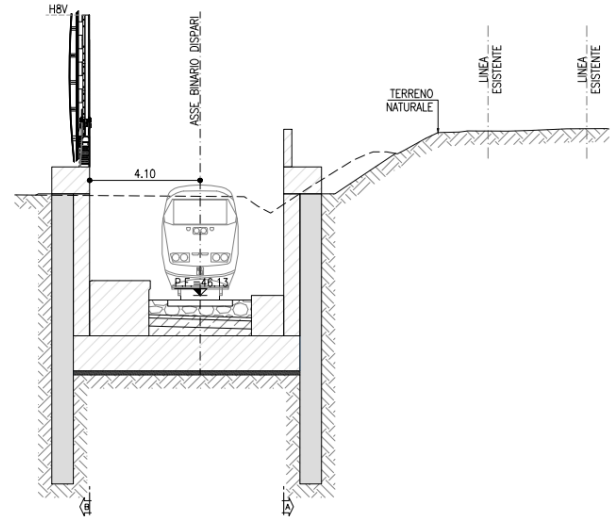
Sezione tipo tipologico BA17 “H8V- Su Muro TR02”
